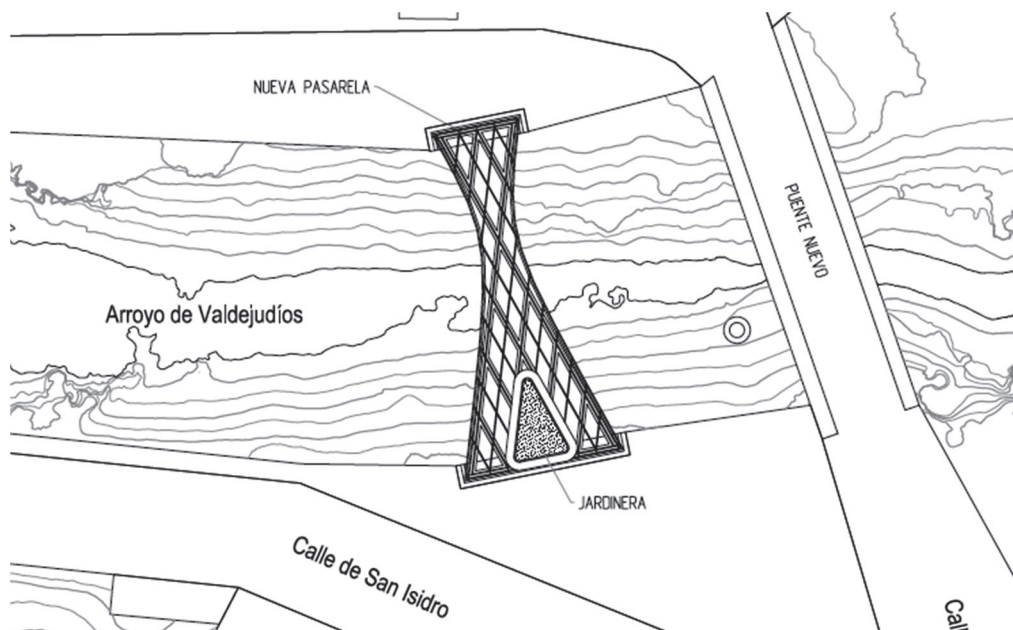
Planta de la alternativa 2, correspondiente a la solución propuesta por el alumno Álvaro Gil.
